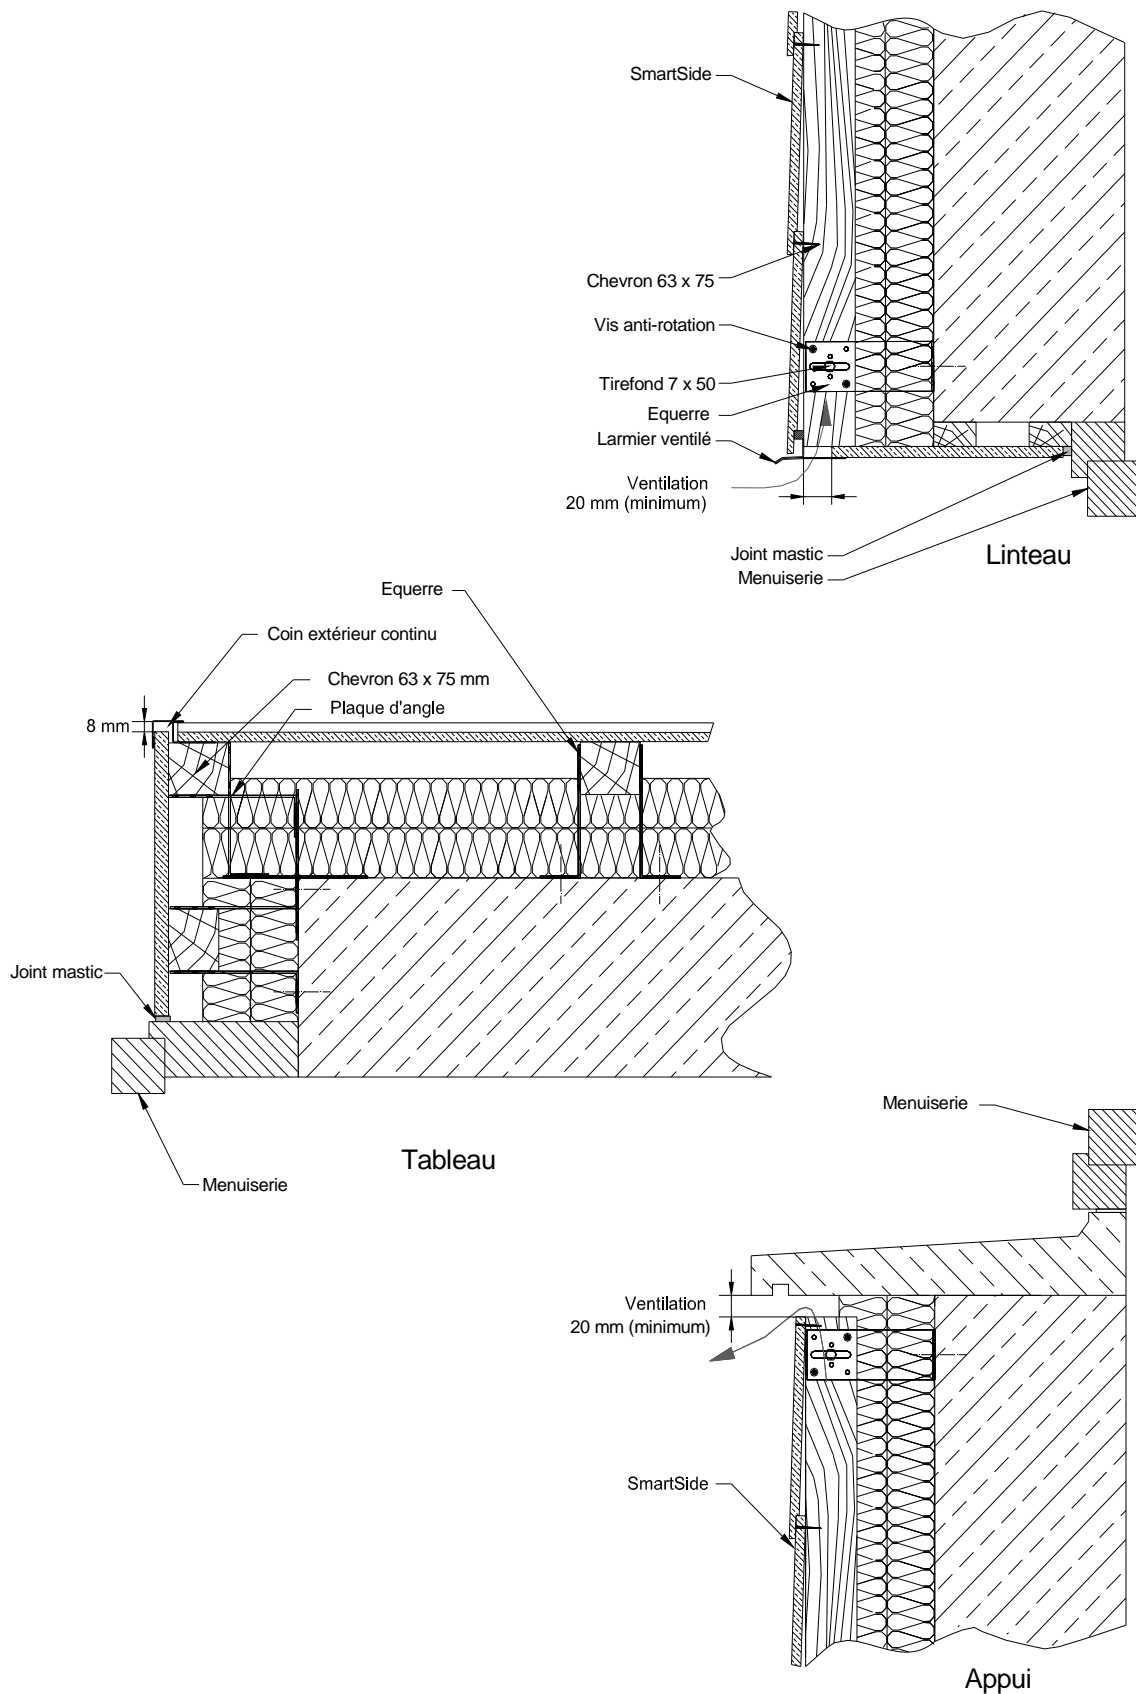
Coupe sur menuiserie avec tableaux – Pose sur maçonnerie avec isolant
